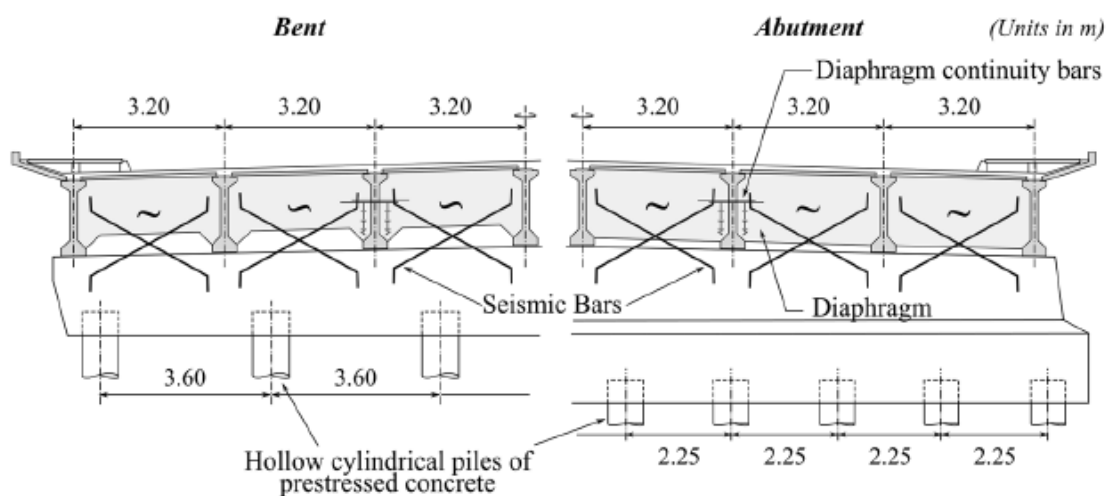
Detalhes da seção transversal da Ponte Juan Pablo II. Fonte: Wilches et al. (2021).
